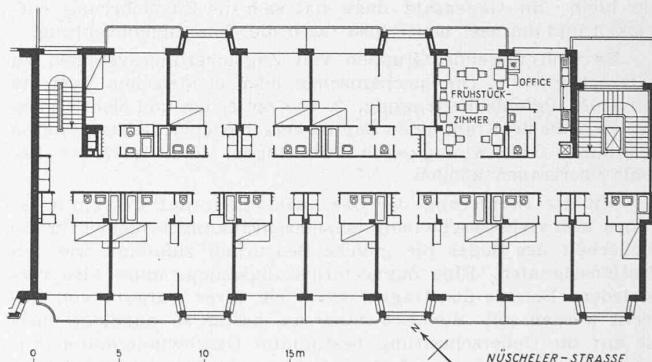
Grundriss vom ersten Stock. — Maßstab 1:400
